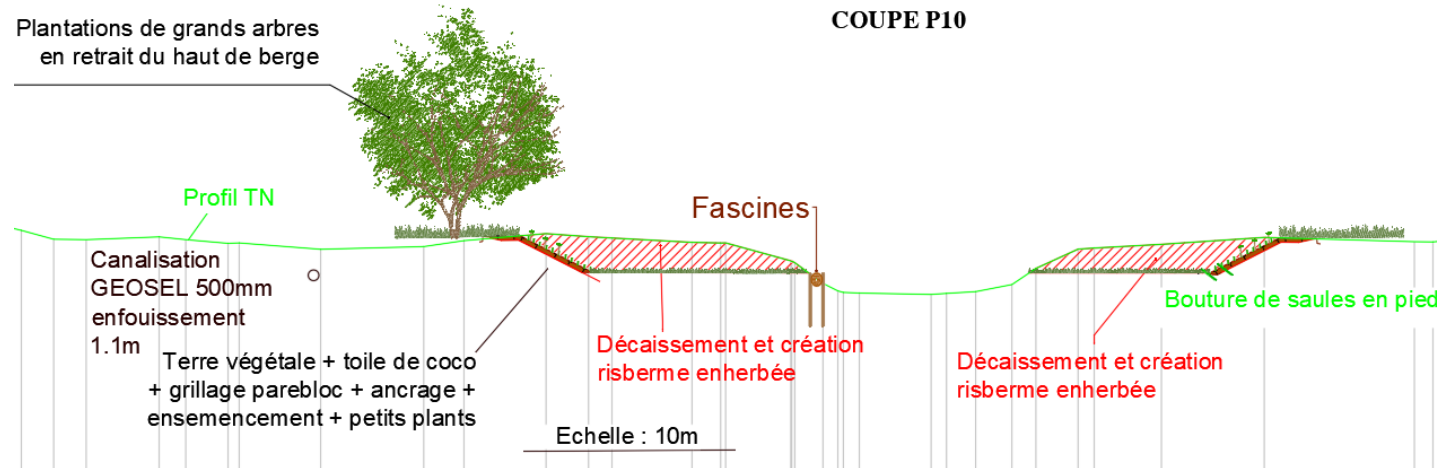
Secteur 4 – Action 8, profil type P10 (élargissement par rive gauche et par rive droite)
